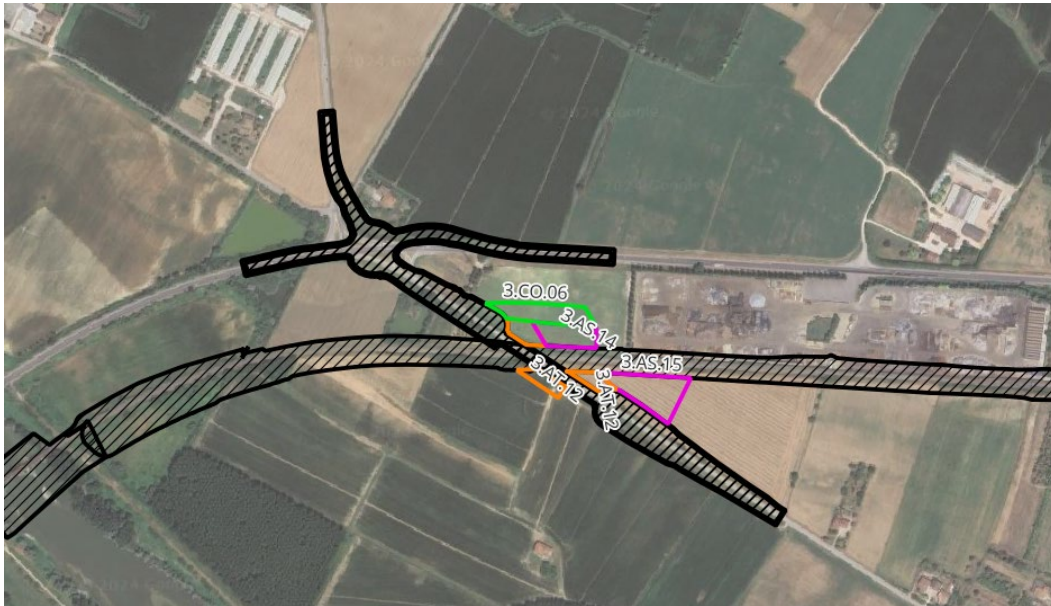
Aree di cantiere e aree di lavoro (retinate in nero). Dettaglio su NV26 e IV26
